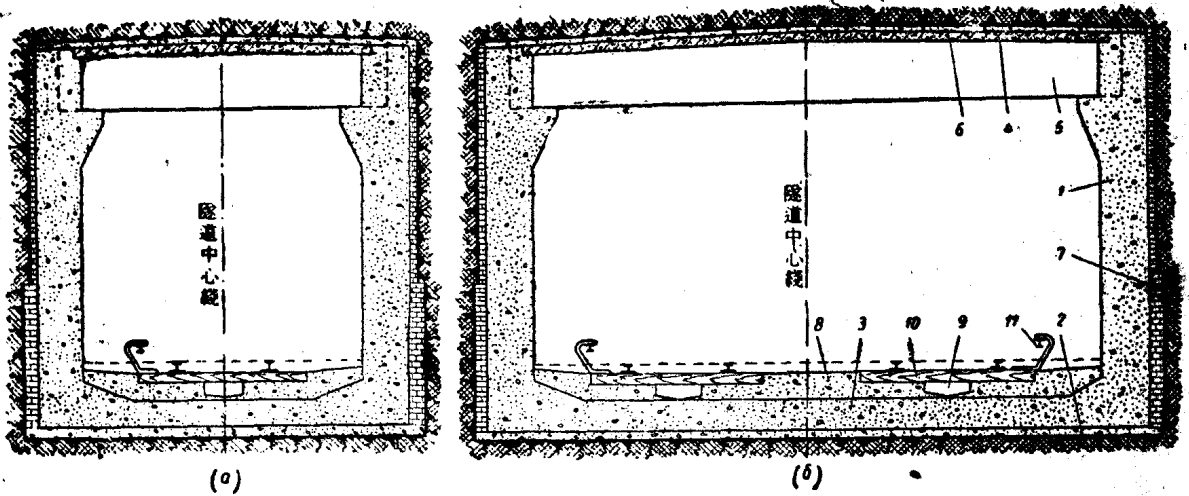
地下鉄道の浅埋混凝土单线 (a) 和双线 (b) 隧道截面图
